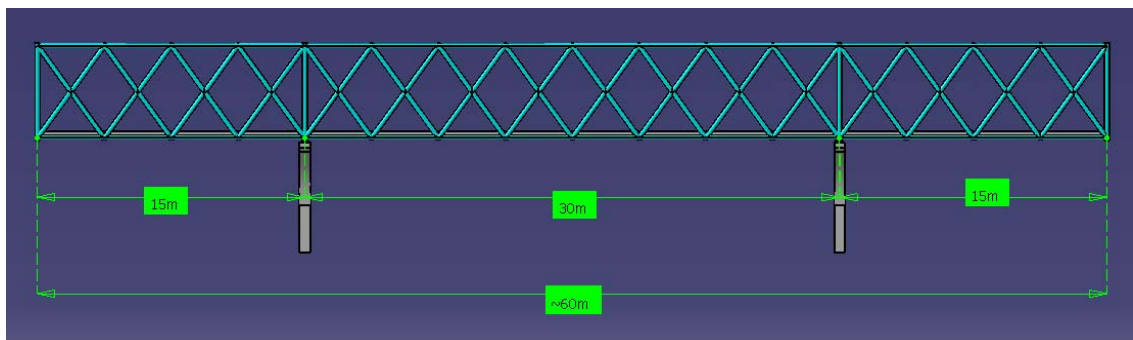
Longitud del puente y longitudes de los vanos entre las pilas.
